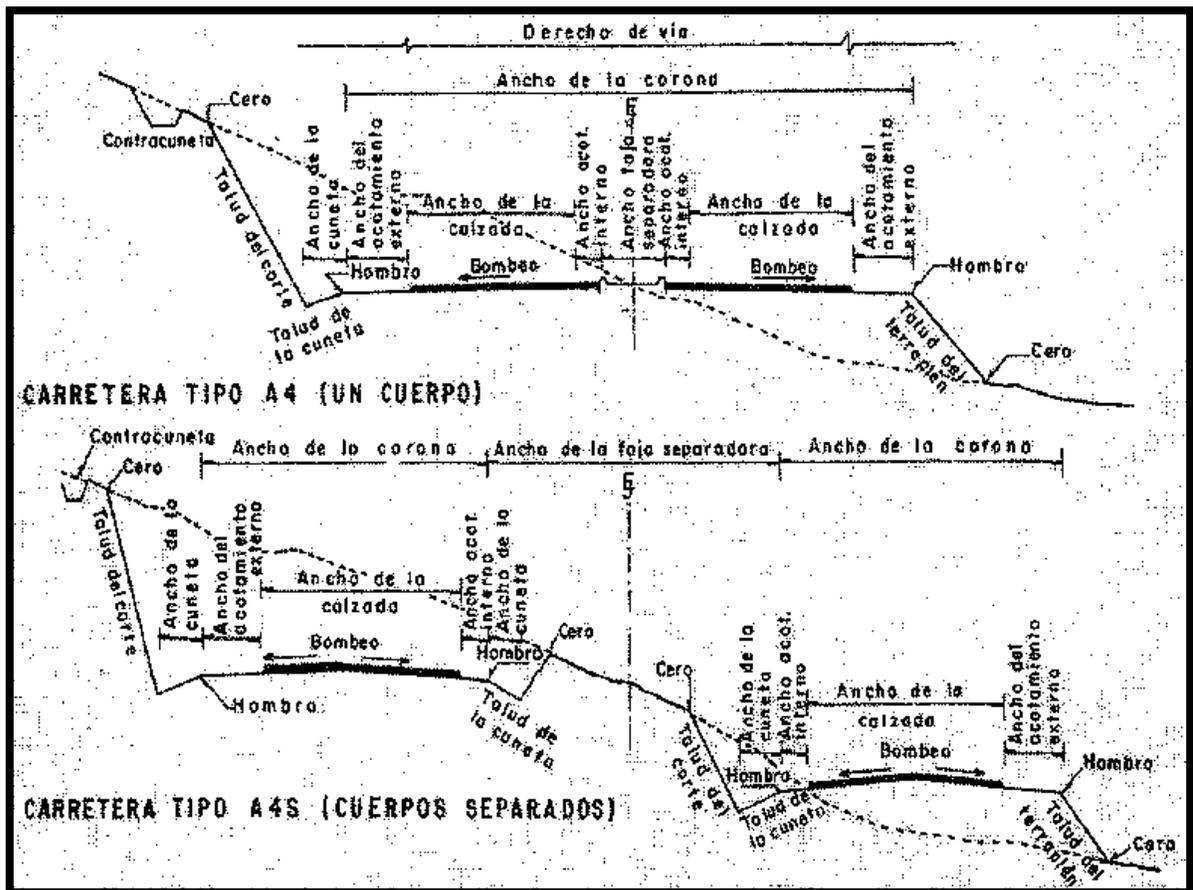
Sección transversal en tangente del alineamiento horizontal para carreteras tipos A4.
